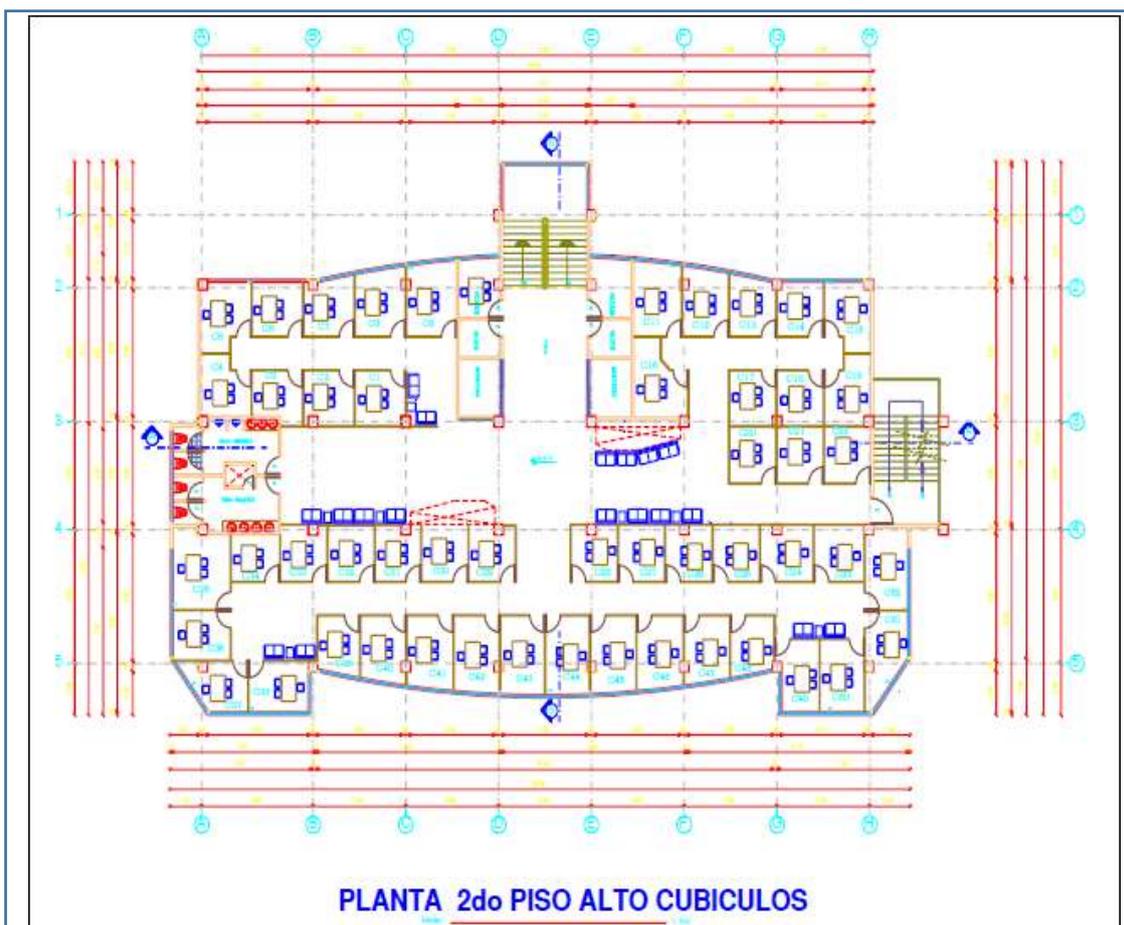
Diseño arquitectónico Planta Segundo Piso alto
